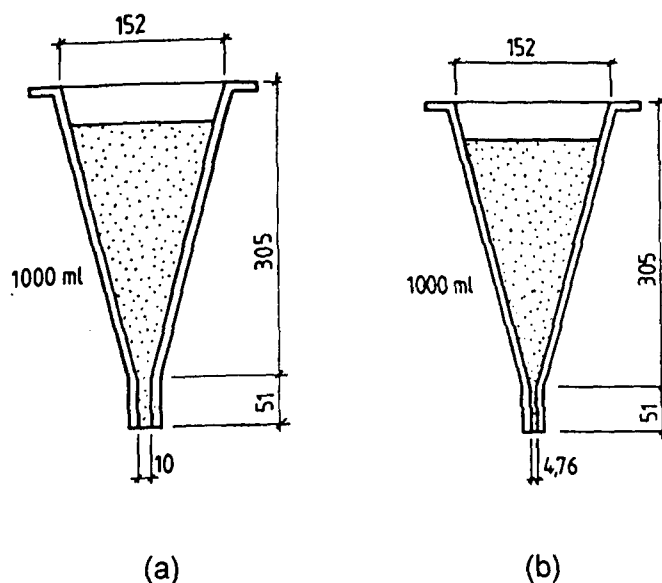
(a) Auslauftrichter mit 10 mm Auslaufdüse, (b) Marsh-Trichter mit 4,76 mm Auslaufdüse
